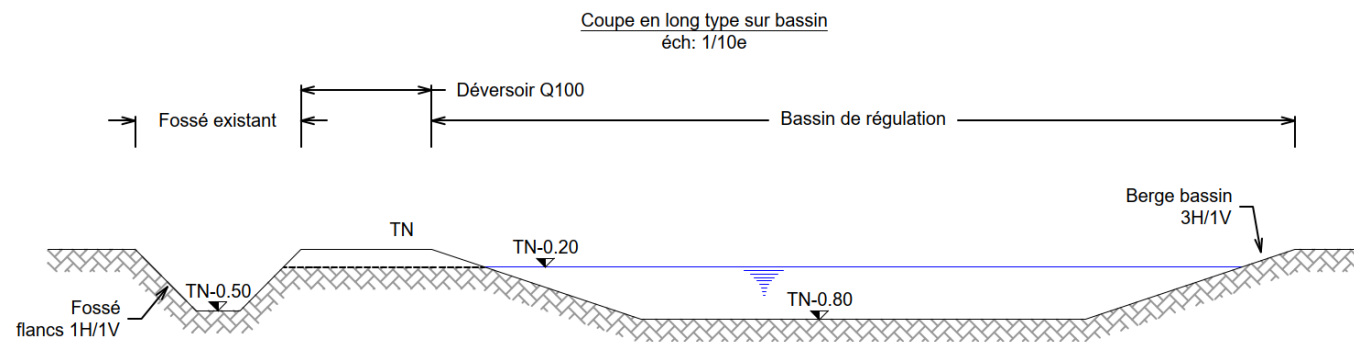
Coupe en long de l'ouvrage du BV n°1
